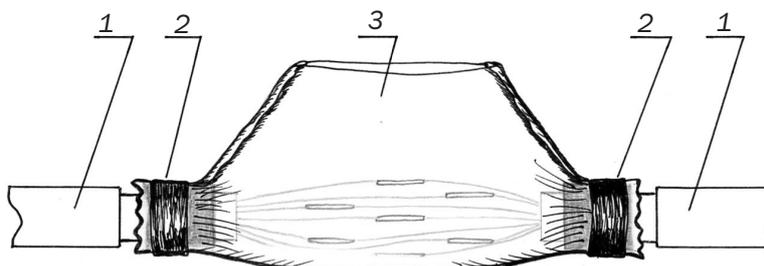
Установка пакета над смонтированным сростком: 1 – полиэтиленовая оболочка; 2 – бандаж из ленты 88Т; 3 – пакет для заливки геля.
